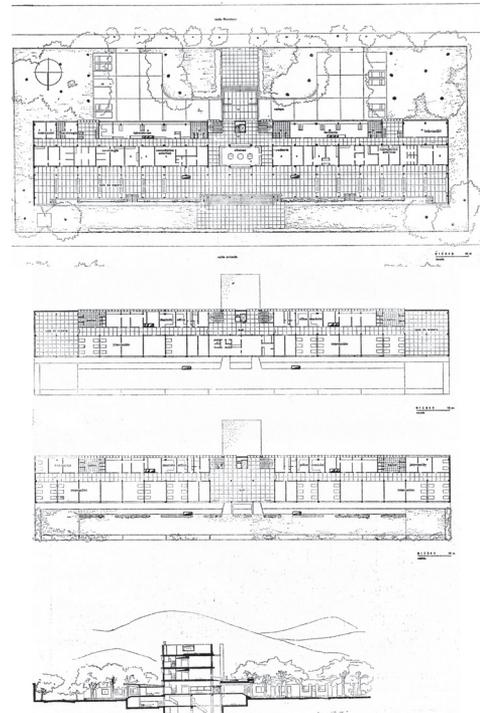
Plantas y corte transversal. Fuente Summa, n°1, p. 51-52
